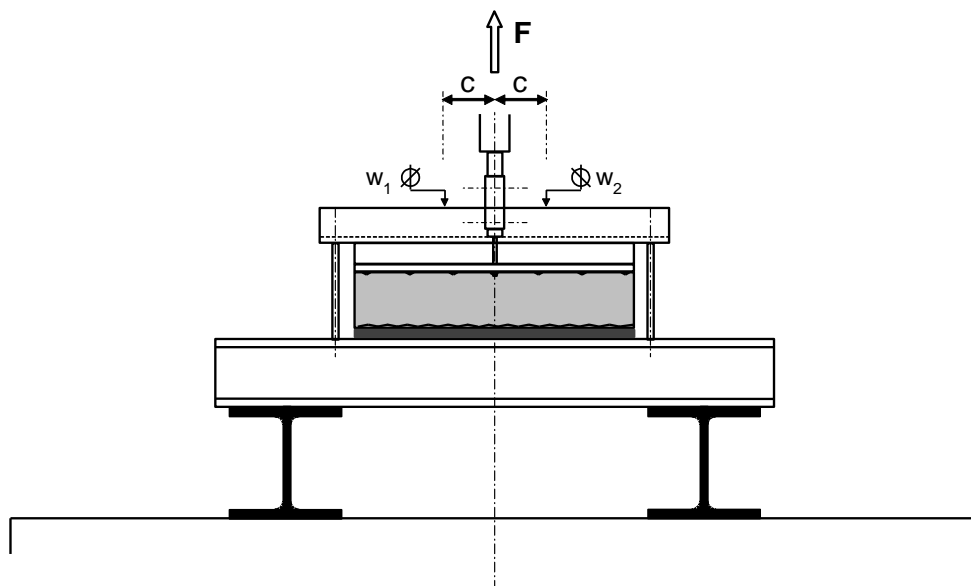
Prinzipskizze Versuchsaufbau Mittelaufleger, Ansicht 2
